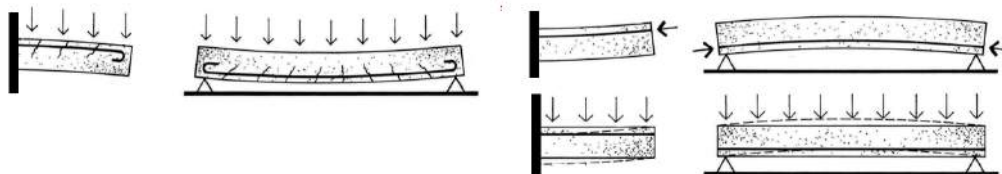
COMPORTAMIENTO HORMIGÓN ARMADO VS POSTESADO
